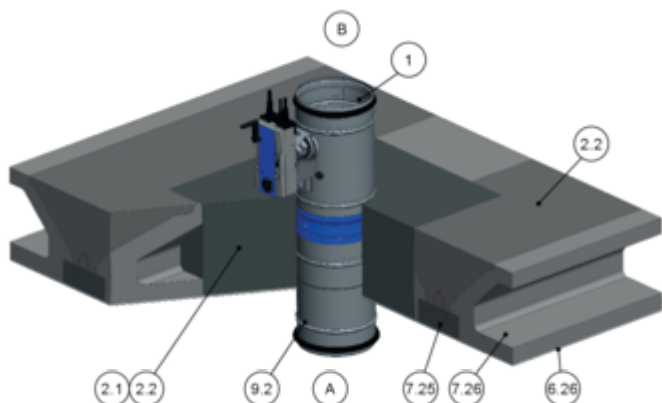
Installazione a base di malta con base di calcestruzzo in un soffitto a soletta piena, verticale, installazione multipla
